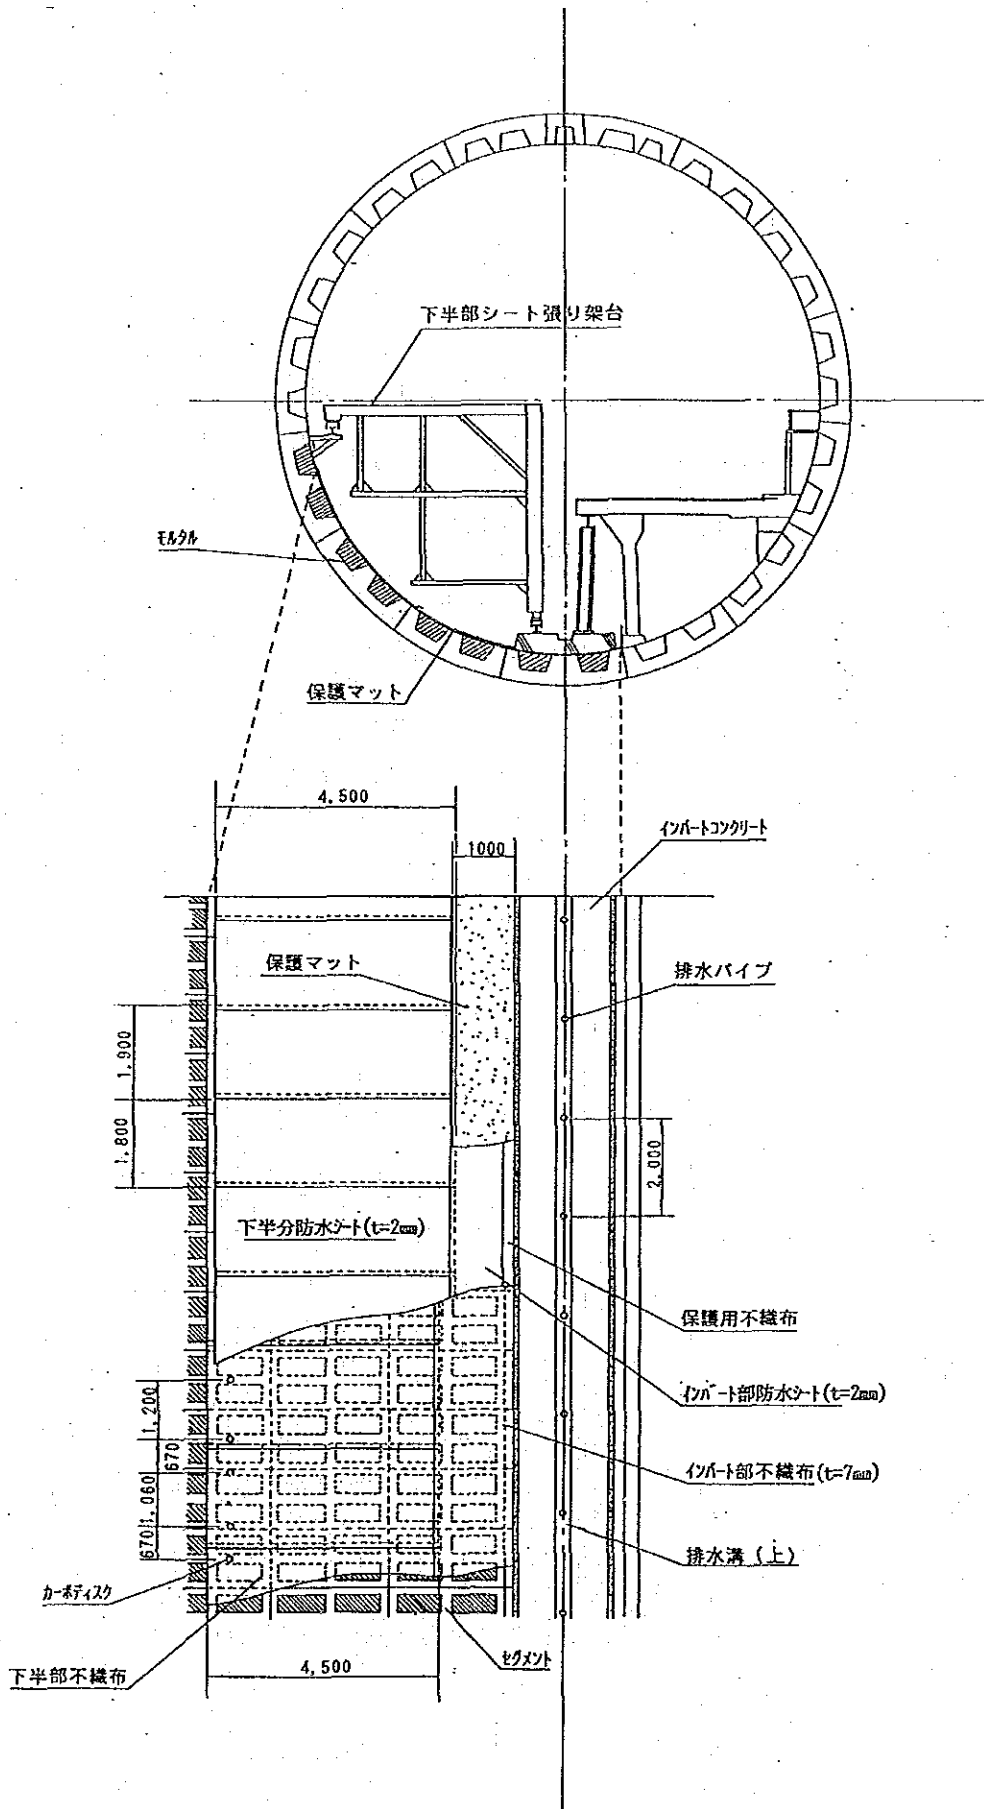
(3)-5 防水シート展開図(下半分施工時(1))
